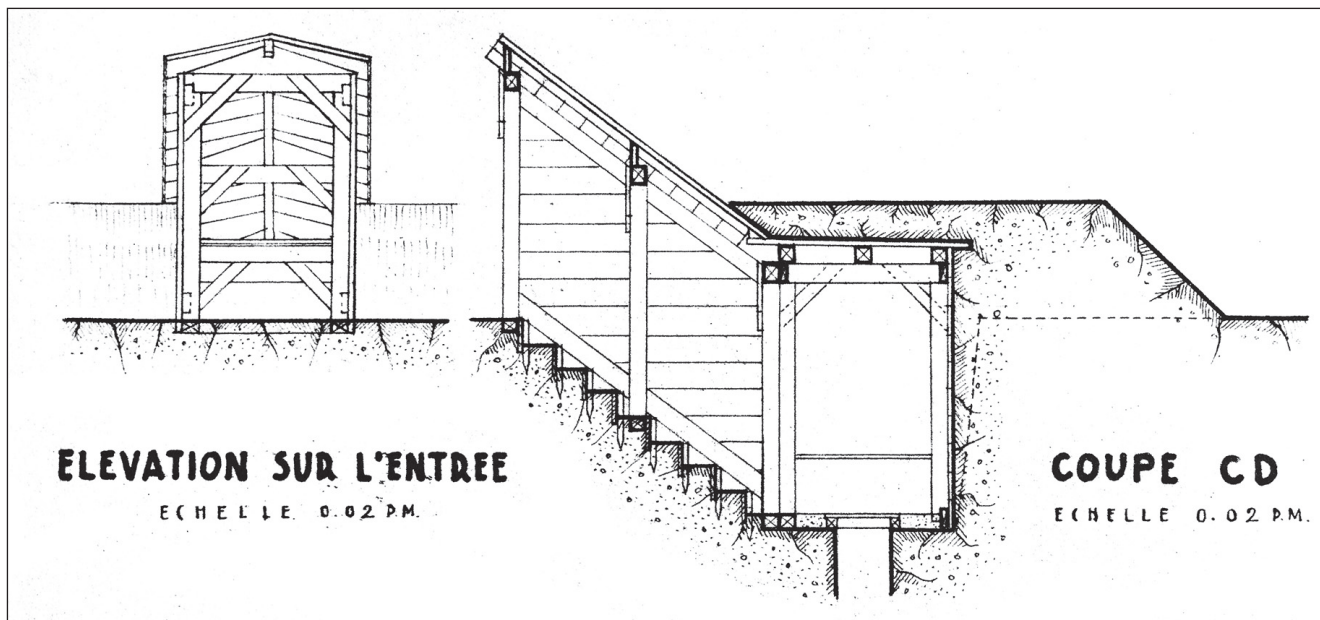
Coupe d'un escalier de tranchée-abri à Gagny, 1942, Arch. mun. Gagny, boîte 1.
